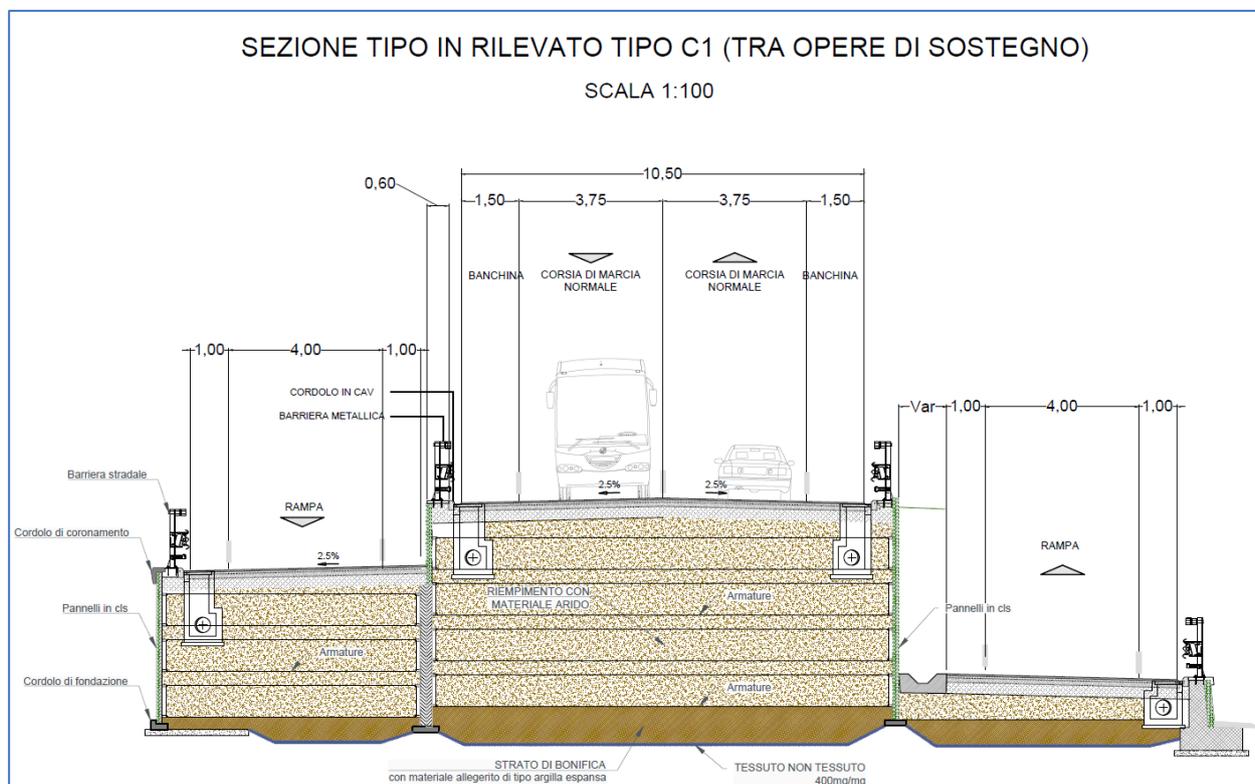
Sezione tipo tra muri con rampe di collegamento laterali
